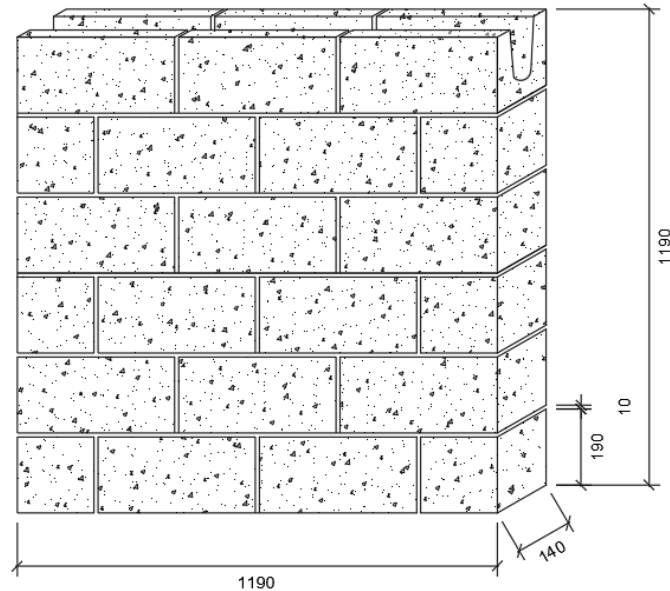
Modelo Miniparede sem viga, dimensões em milímetros. Fonte: Próprio autor
